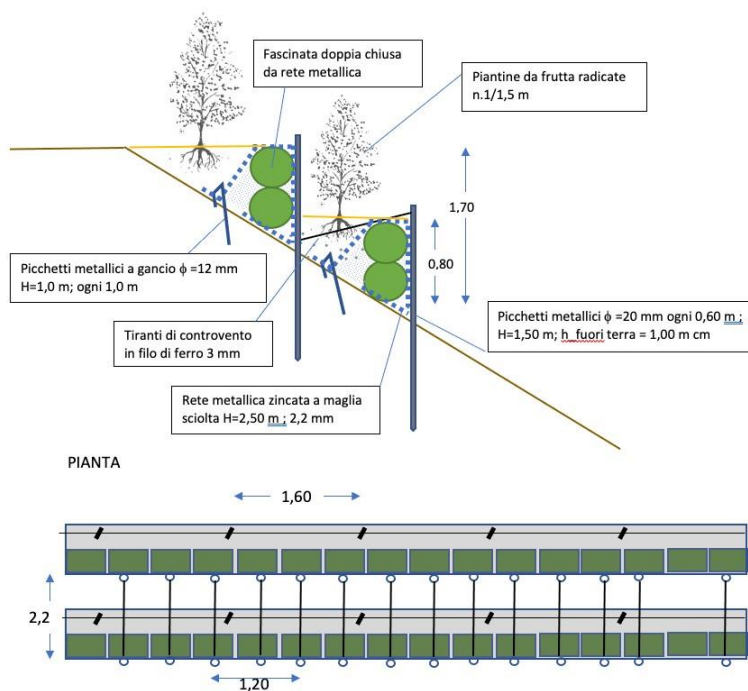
Schema di sezione tipo e pianta prototipo B1.
